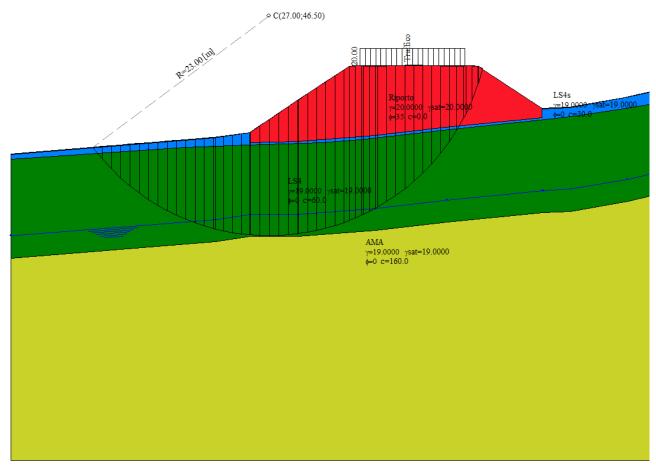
Verifica di stabilità globale - condizione statica non drenata
